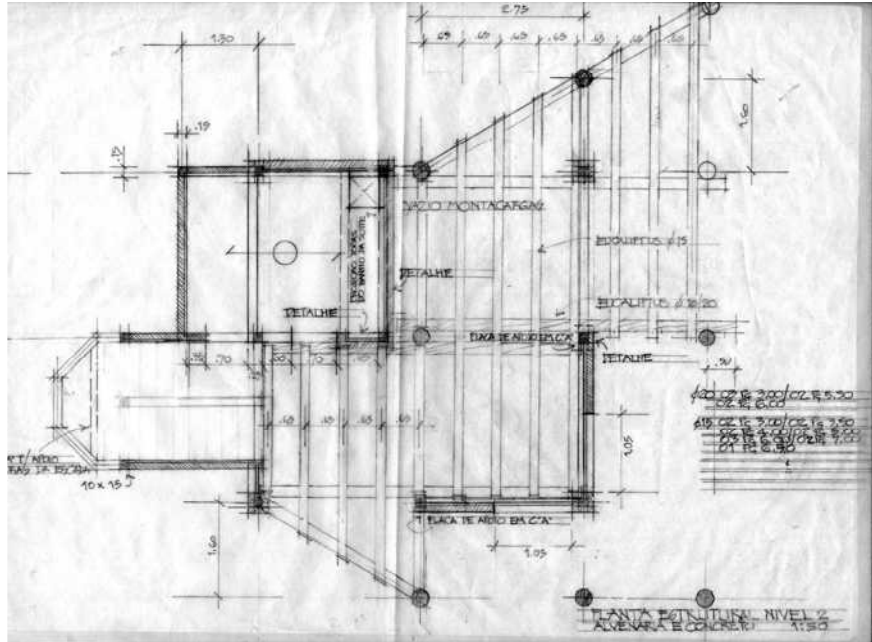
Plantas baixas com estudo estrutural - níveis 2 e 3
